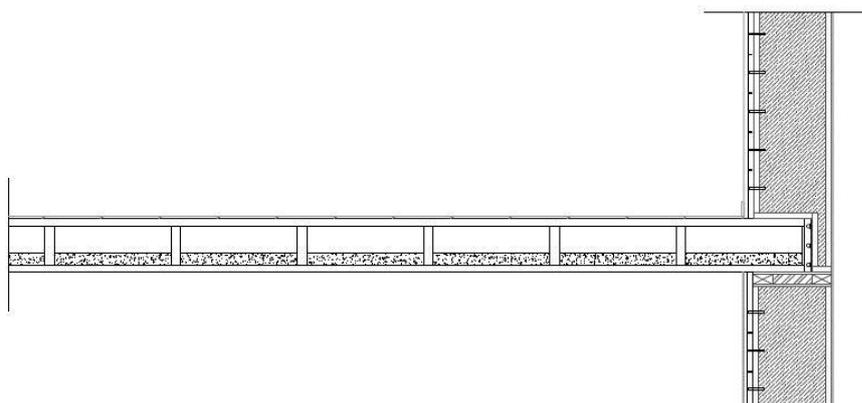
Apoyo de estructura en cerramiento. Fuente: Elaboración propia.
